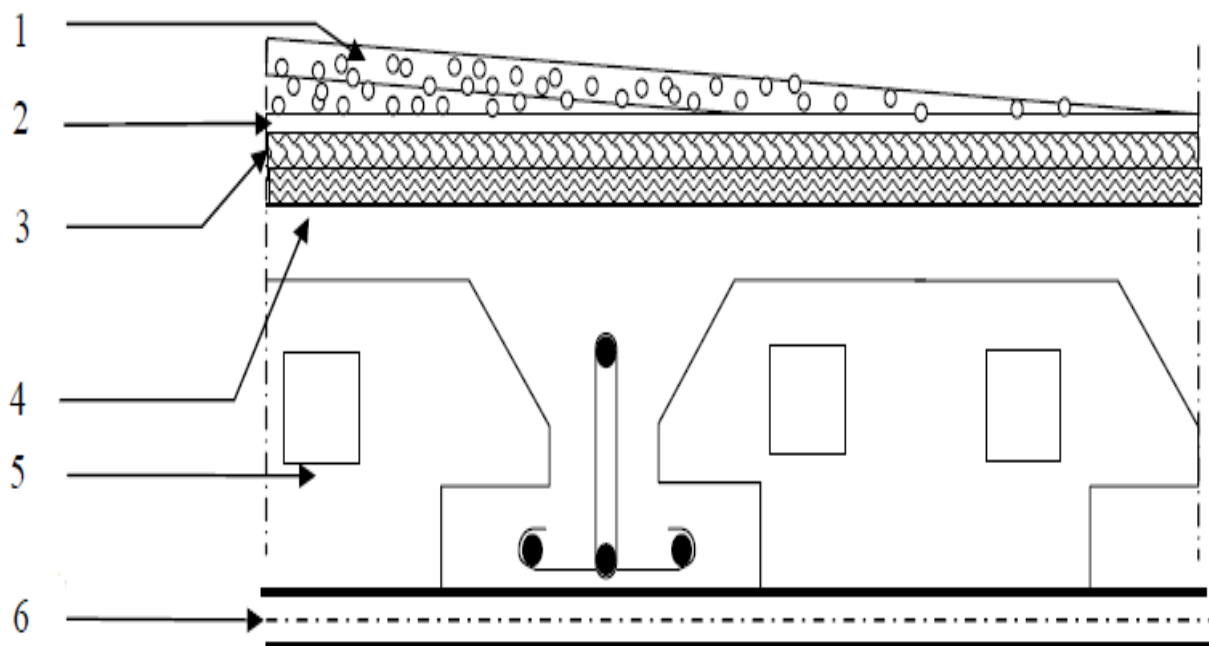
Elément constituant le plancher terrasse inaccessible
